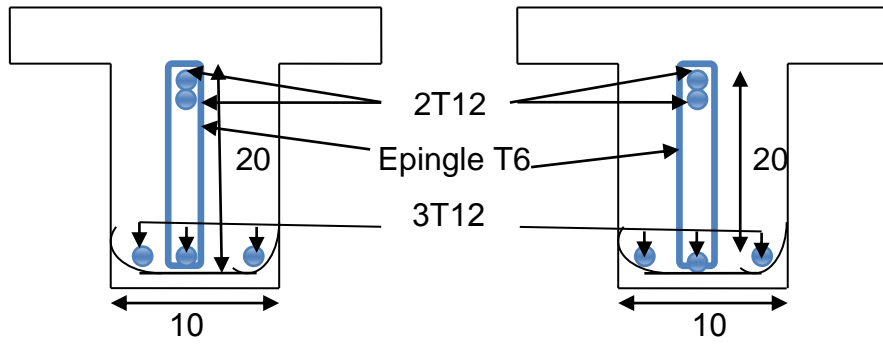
Ferrailage des poutrelles (appui de rive et appui intermédiaire).
